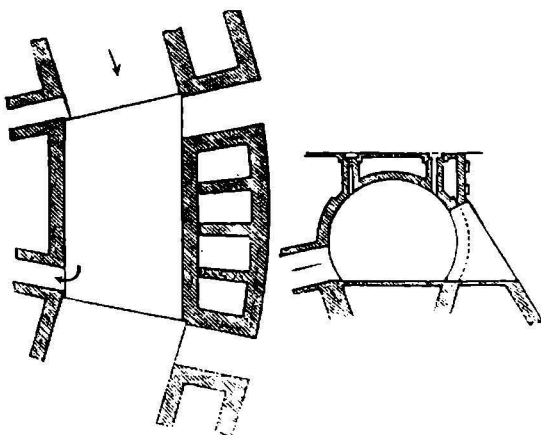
Verbesserungen des Ofenkanals, Detail des Grundrisses und Querschnitt
